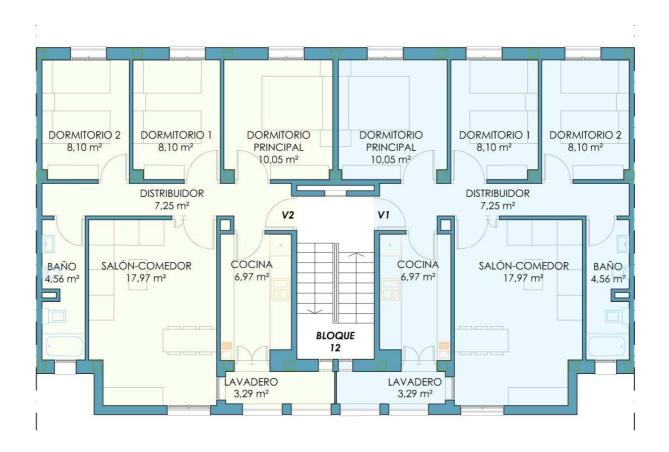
Plano Planta Primera y Segunda; bloque 12.16
